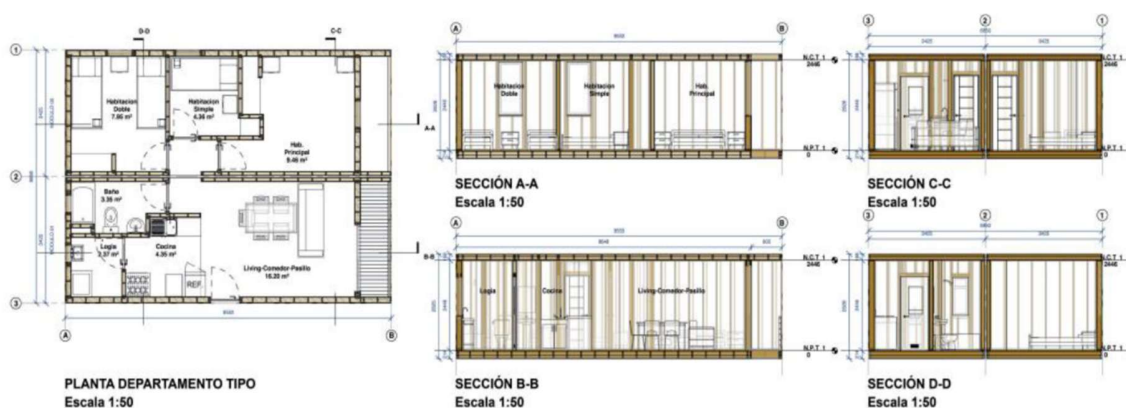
Detalle Planta y Secciones departamento tipo – Lo Espejo. Fuente: Archiplan
